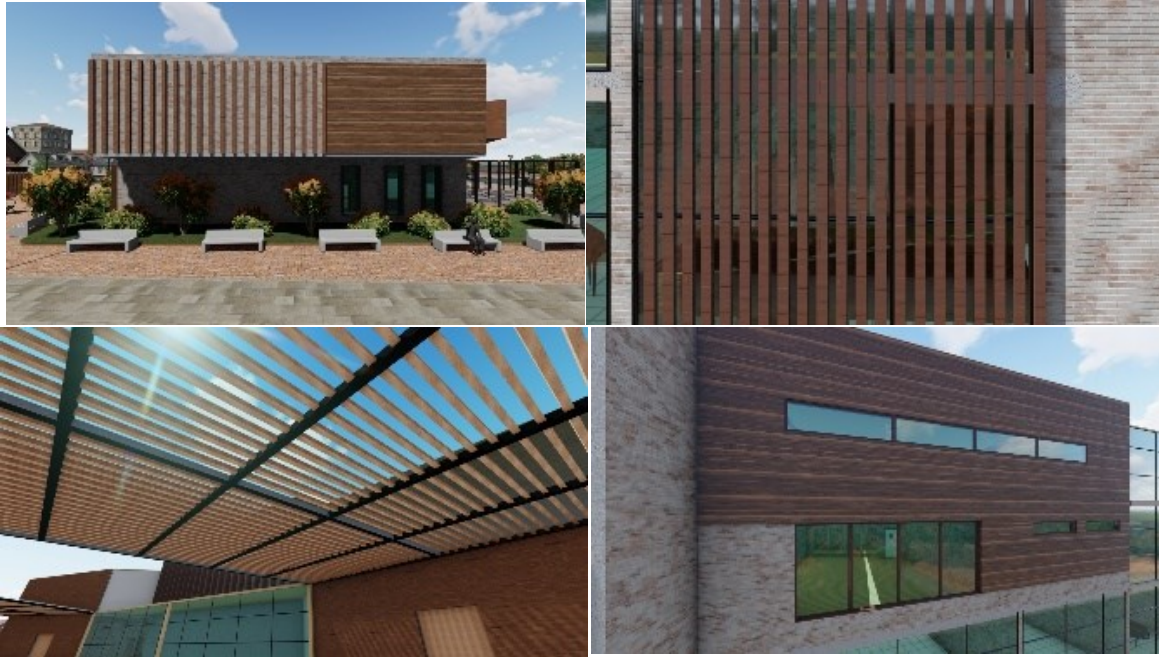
Aplicación madera en el equipamiento (sala de cámara, fachada frontal, pérgola, salones).
